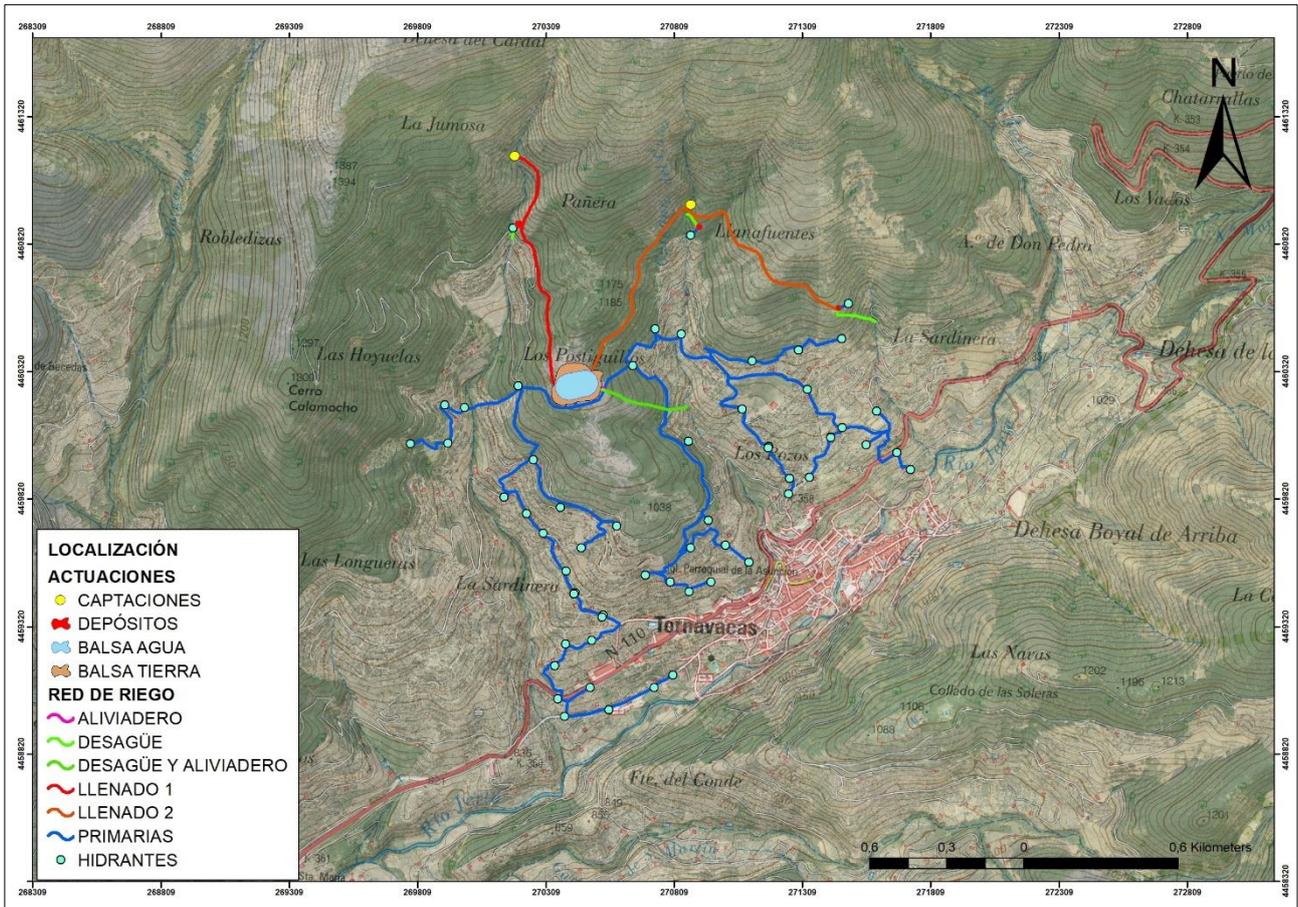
Plano detalle zona de actuación. Fuente: Elaboración propia, 2023.
